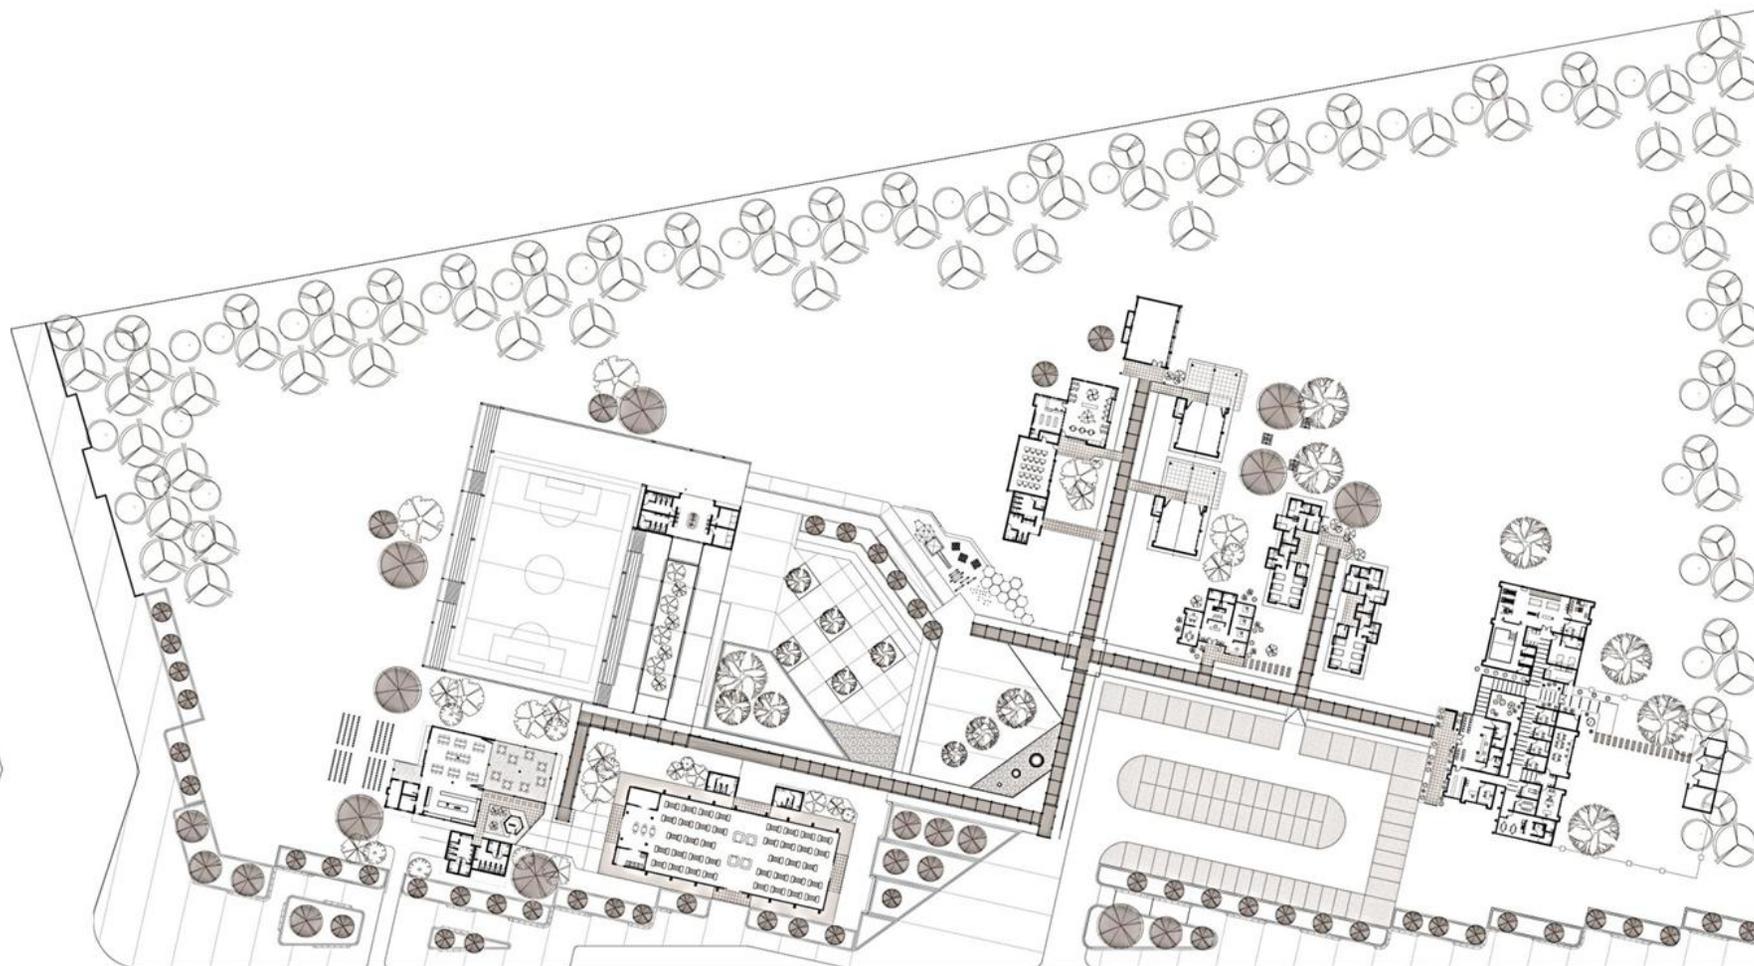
Plano de conjunto de la propuesta arquitectónica. Fuente: Elaboración propia
